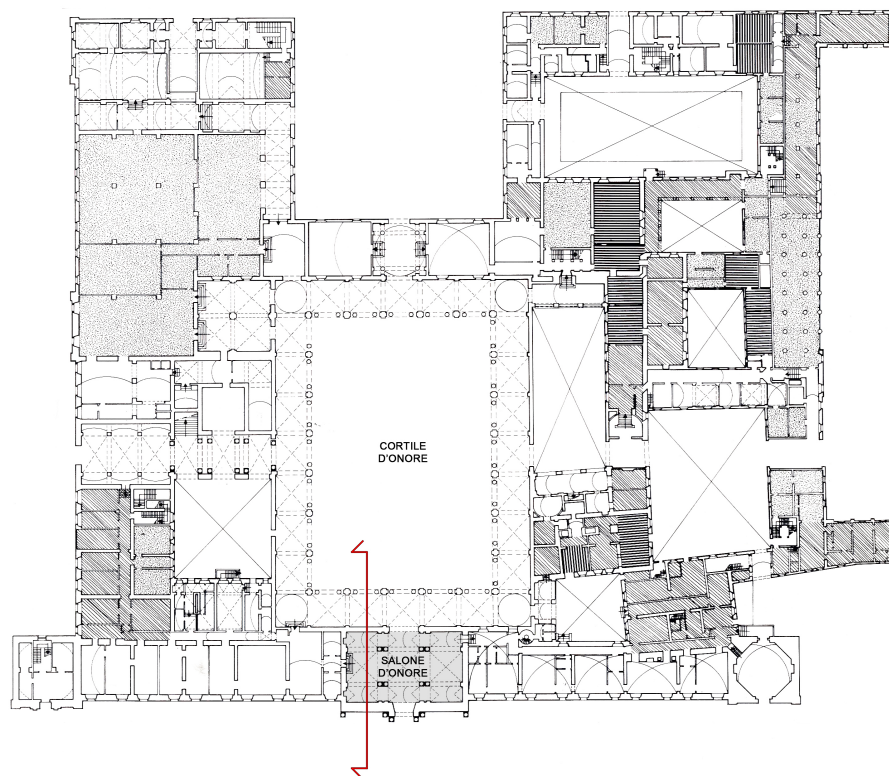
Pianta del piano terra dell'Accademia militare con indicazione della sezione sulla quale sono stati posizionati gli accelerometri
